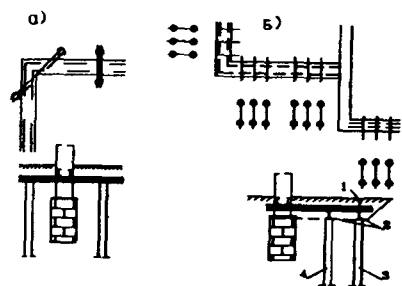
Передача нагрузок в существующих зданиях на выносные опоры.
